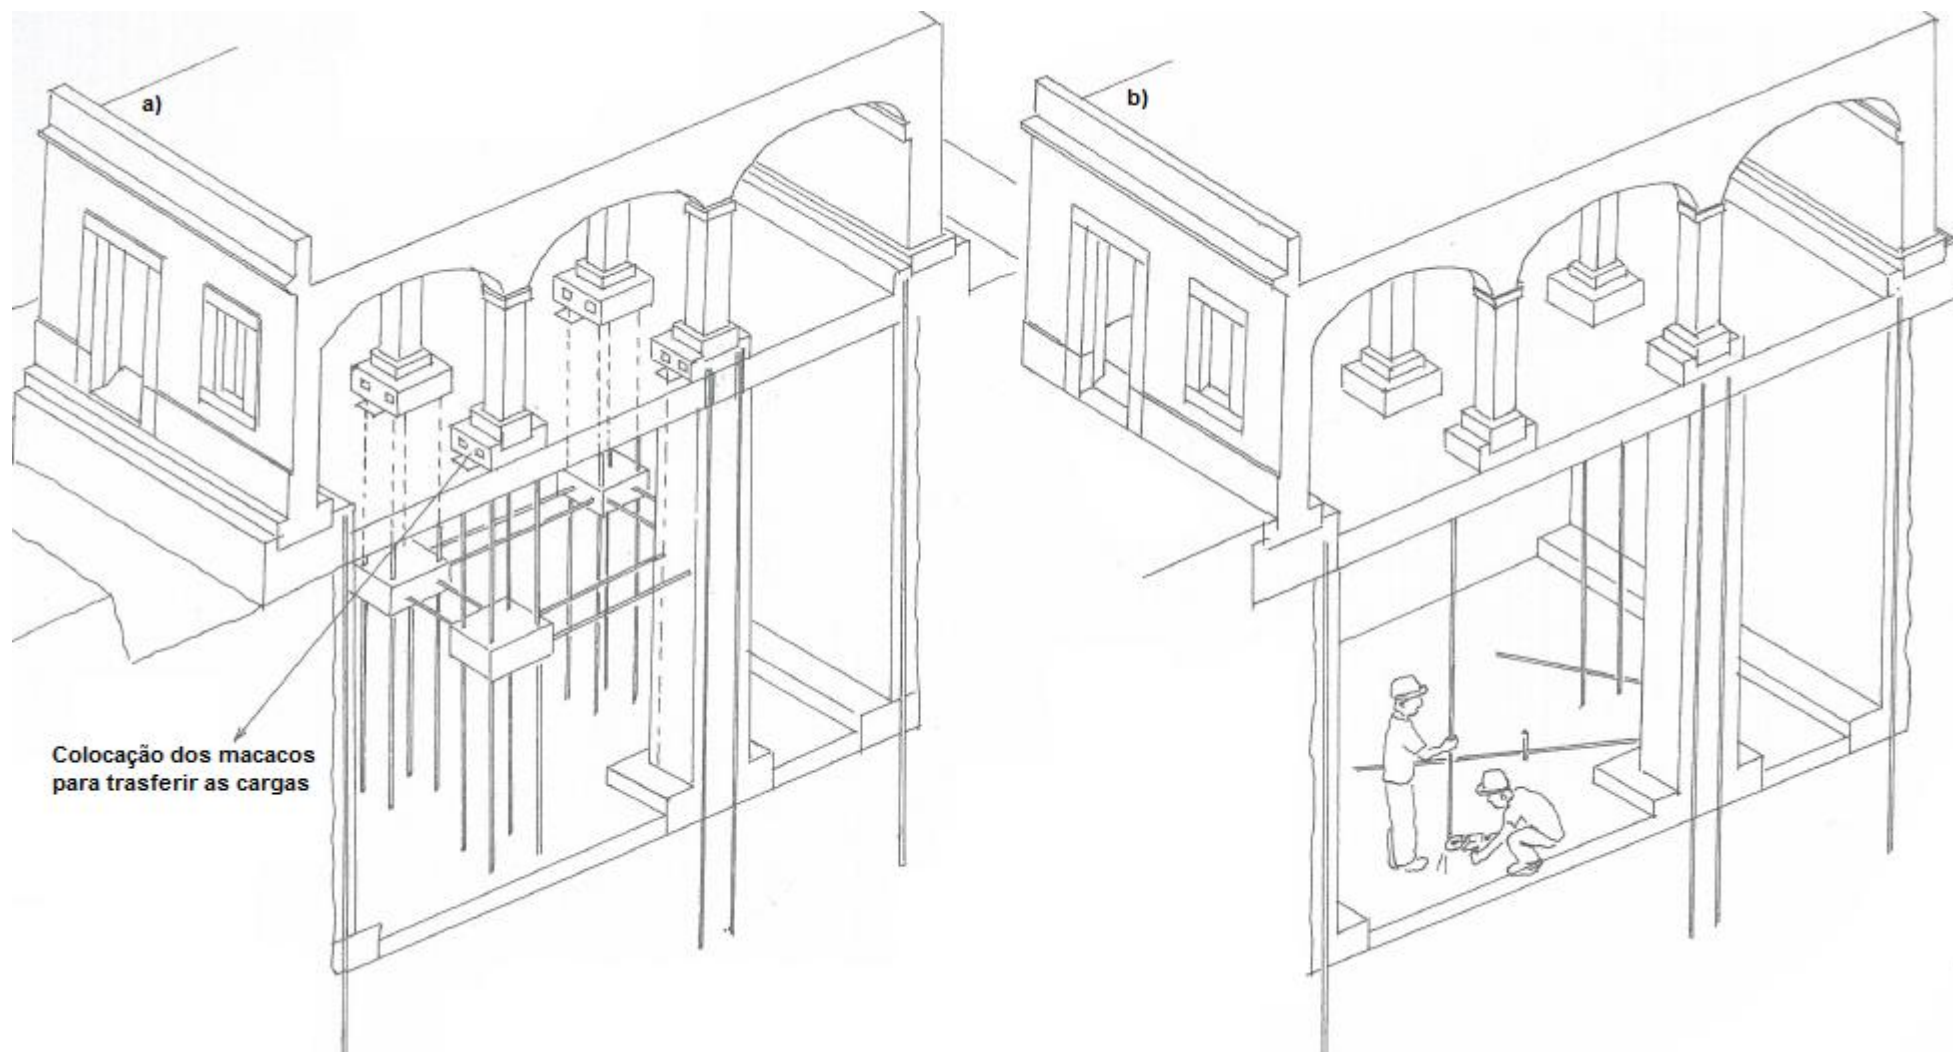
Construção da cave: a) colocação em carga das sapatas isoladas; b) corte das microestacas [55]
